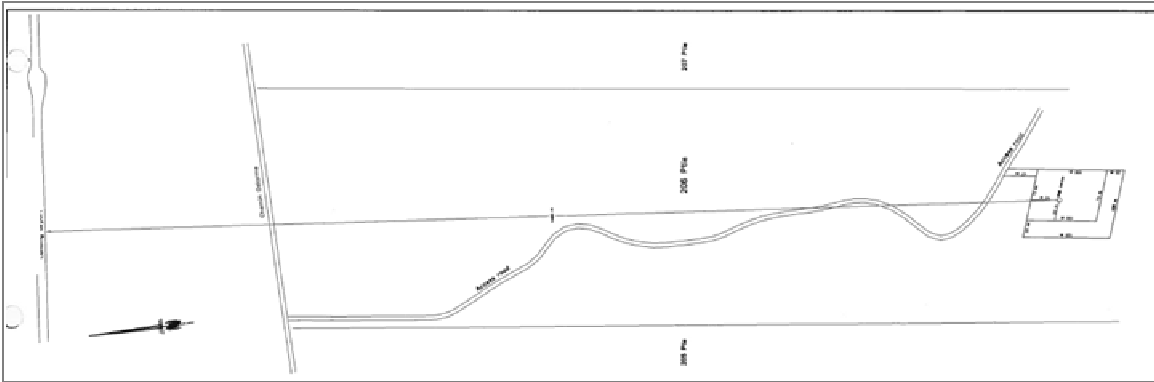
Exemple de plan d’arpentage typique avec route d’accès, plan du site de forage.
